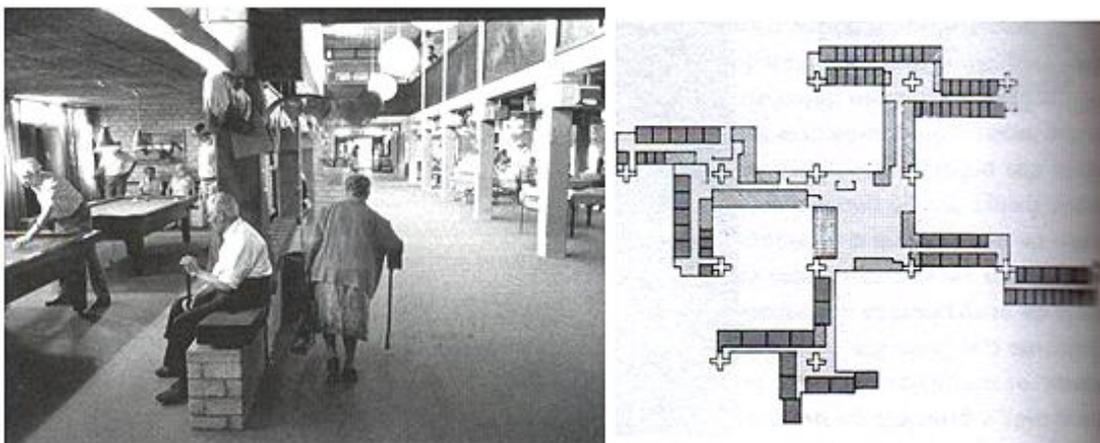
De Drie Hoven, Holanda. Articulação dos espaços – planta e imagem.
